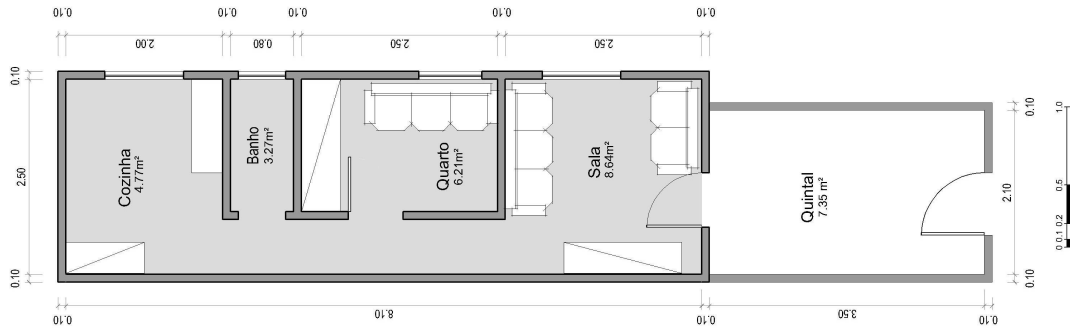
Planta baixa da casa com 34,24m<sup>2</sup>.
